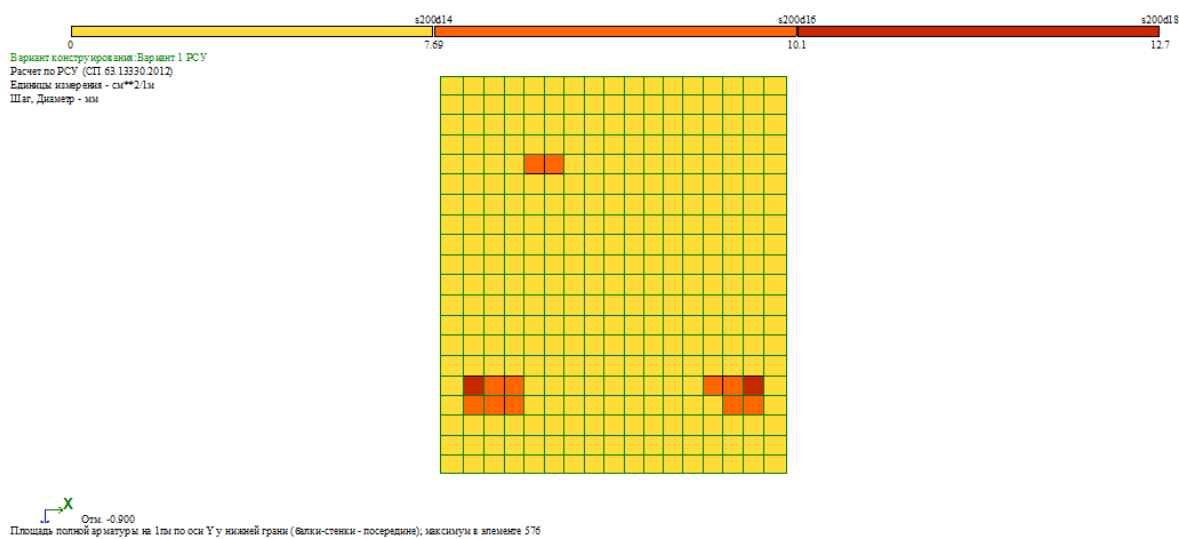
По оси Y нижней грани – площадь полной арматуры 1 п.м.
